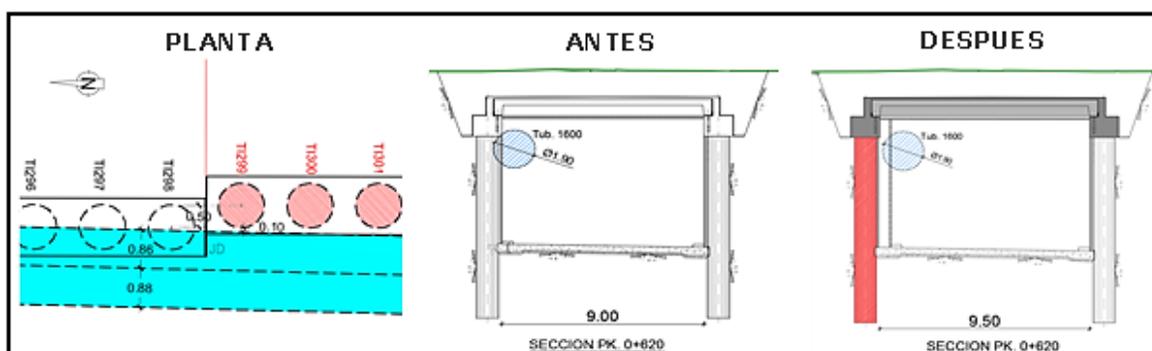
Planta y secciones antes y después de la Adecuación de la Ingeniería
